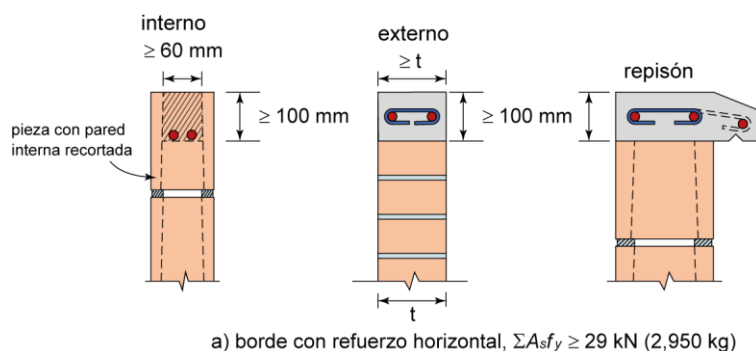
Refuerzo en borde inferior de ventanas y extremo superior de pretil
